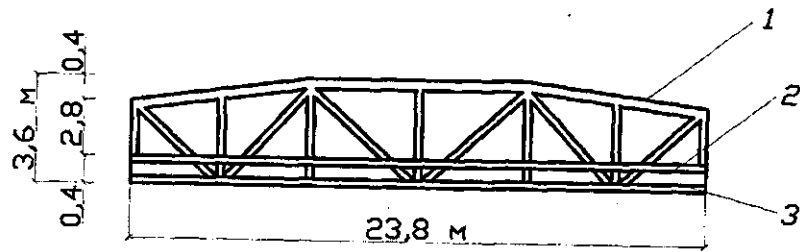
Ферма с новым нижним поясом: 1 — фермы; 2 — новый нижний пояс; 3 — обрезаемые участки элементов фермы
